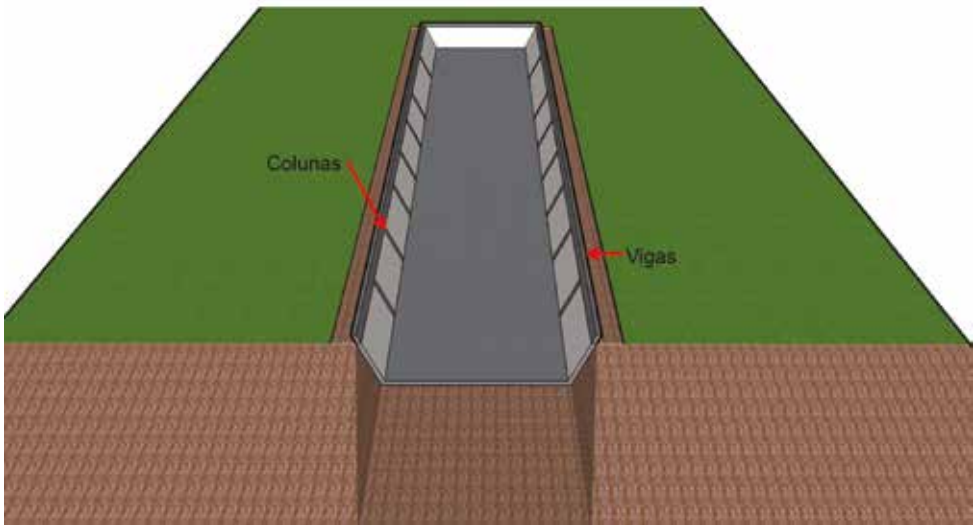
Detalhe da estrutura de vigas e colunas num silo tipo trincheira, construído em alvenaria
